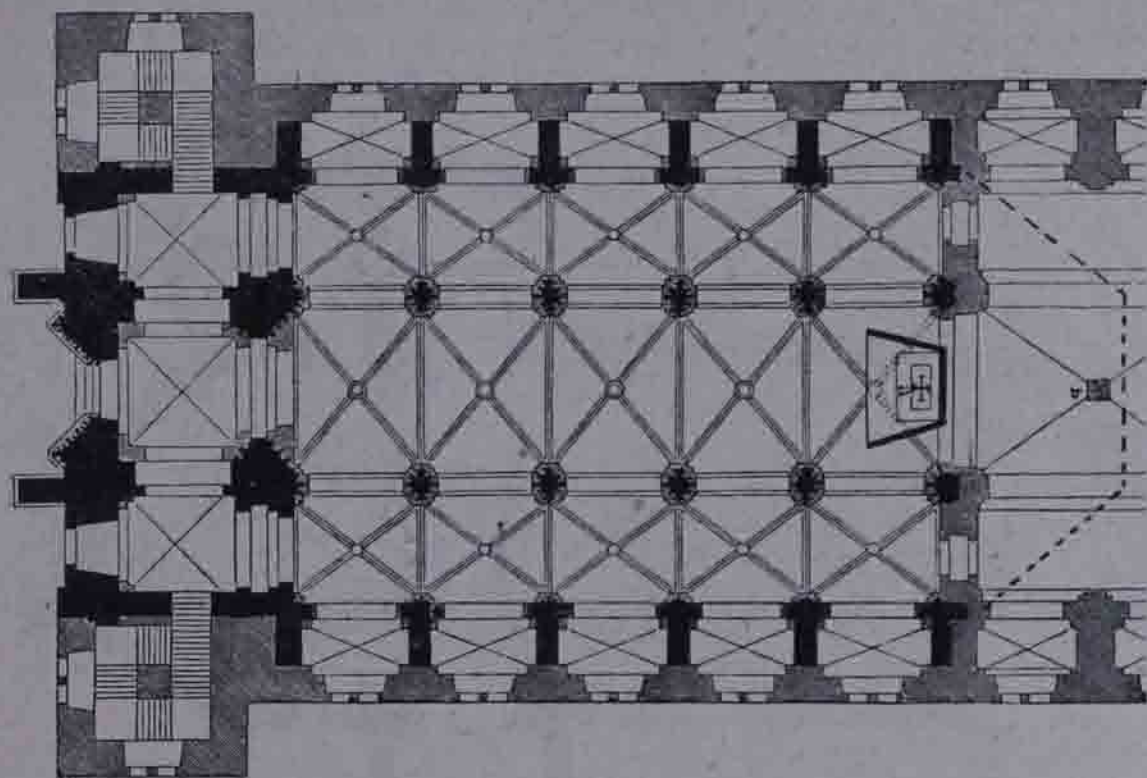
, Mariazell, Wallfahrtskirche; Grundriß des Westteiles.
